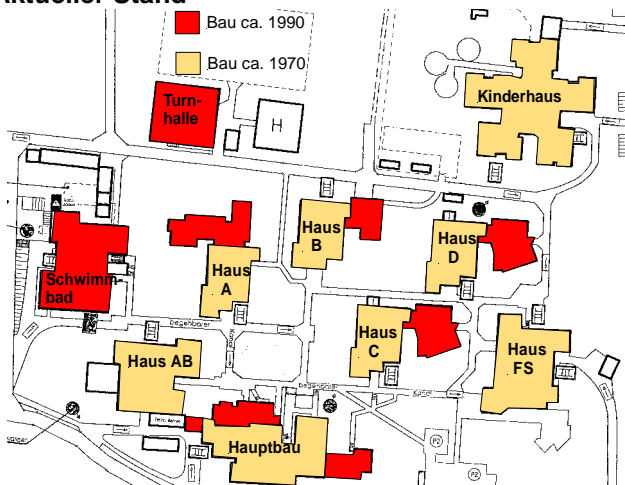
Lageplan der Gebäude des Hegau-Jugendwerkes
